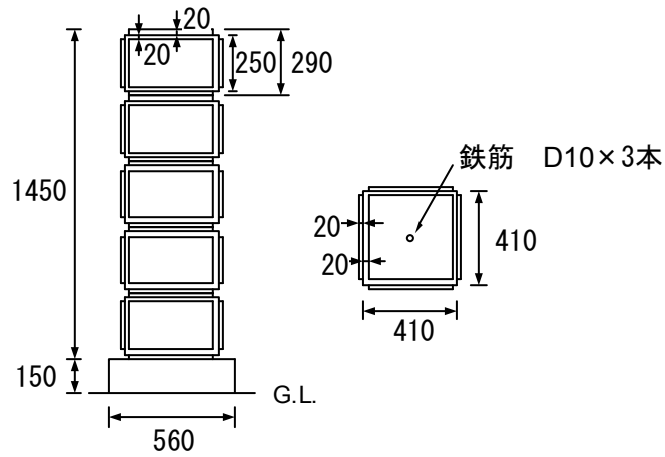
転倒した石造門柱立面図・断面図 (単位: mm)
